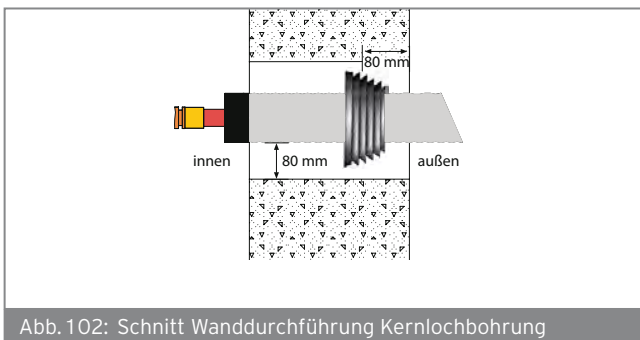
Schnitt Wanddurchführung Kernlochbohrung
